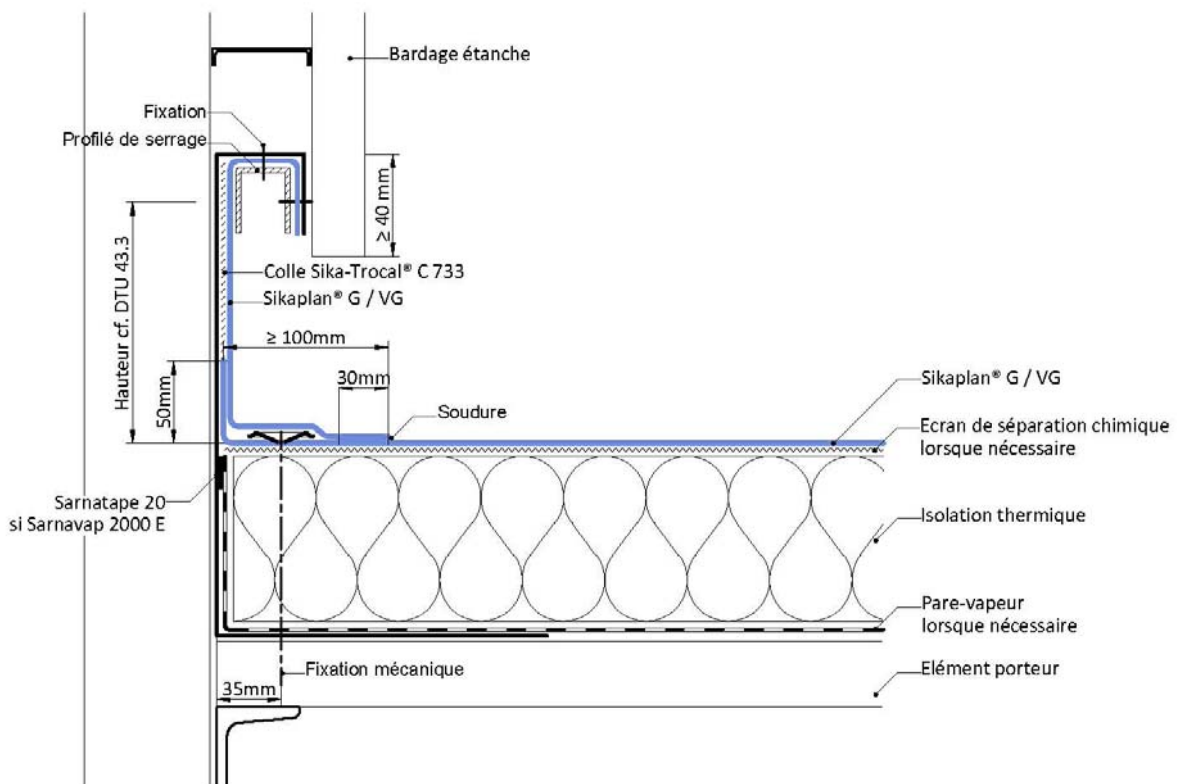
Relevé d'étanchéité – Travaux neufs sur tôles d'acier nervurées
